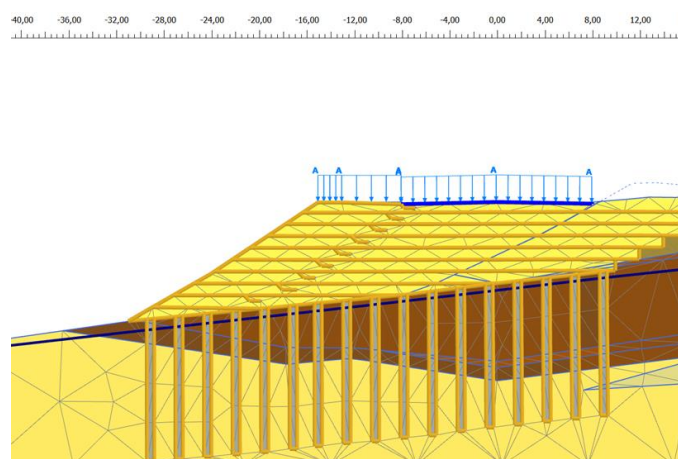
Модель расчетной осадки армонасыпи и грунтового основания с щебеночными сваями в виде сети КЭ.
